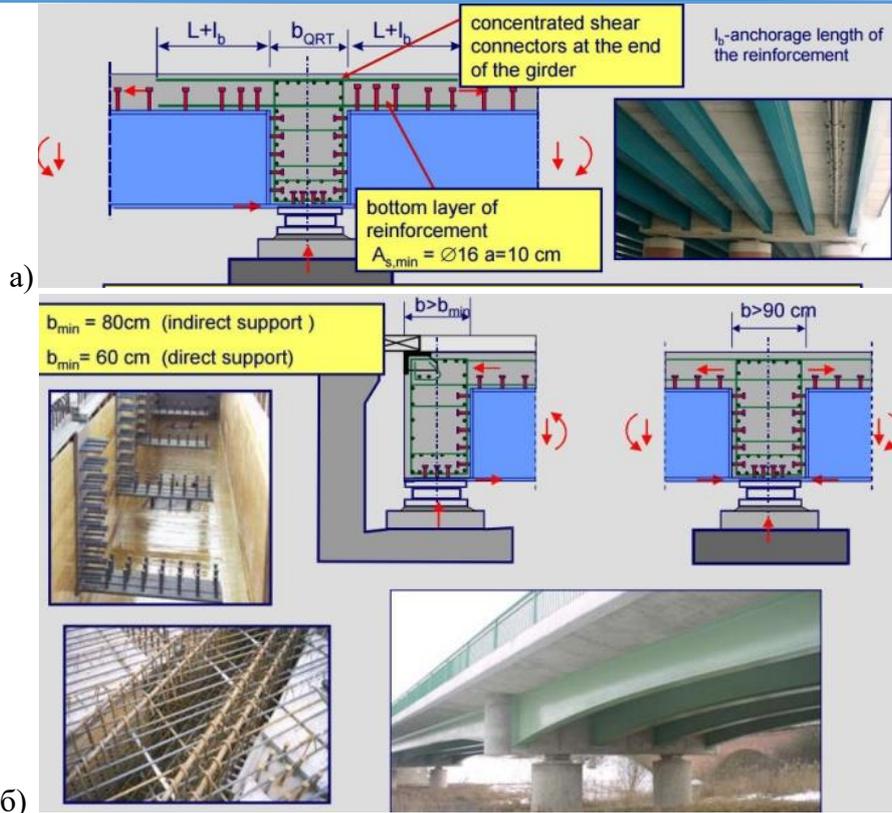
Сталежелезобетонные пролетные строения, имеющие объединение железобетонными балками над опорами: а) конструкция пролетного строения; б) конструкция объединения [1]
